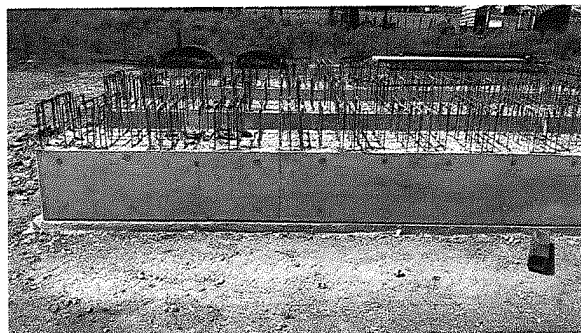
y 17 – Vigas prefabricadas desencofradas
